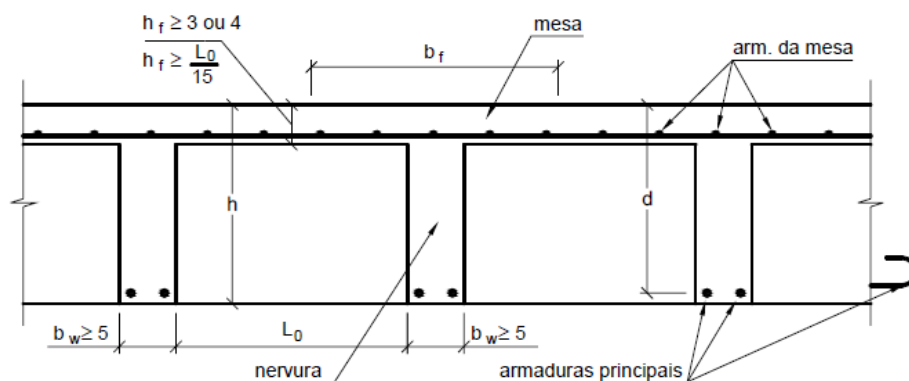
Seção transversal de uma laje nervurada (dimensões em centímetros).
